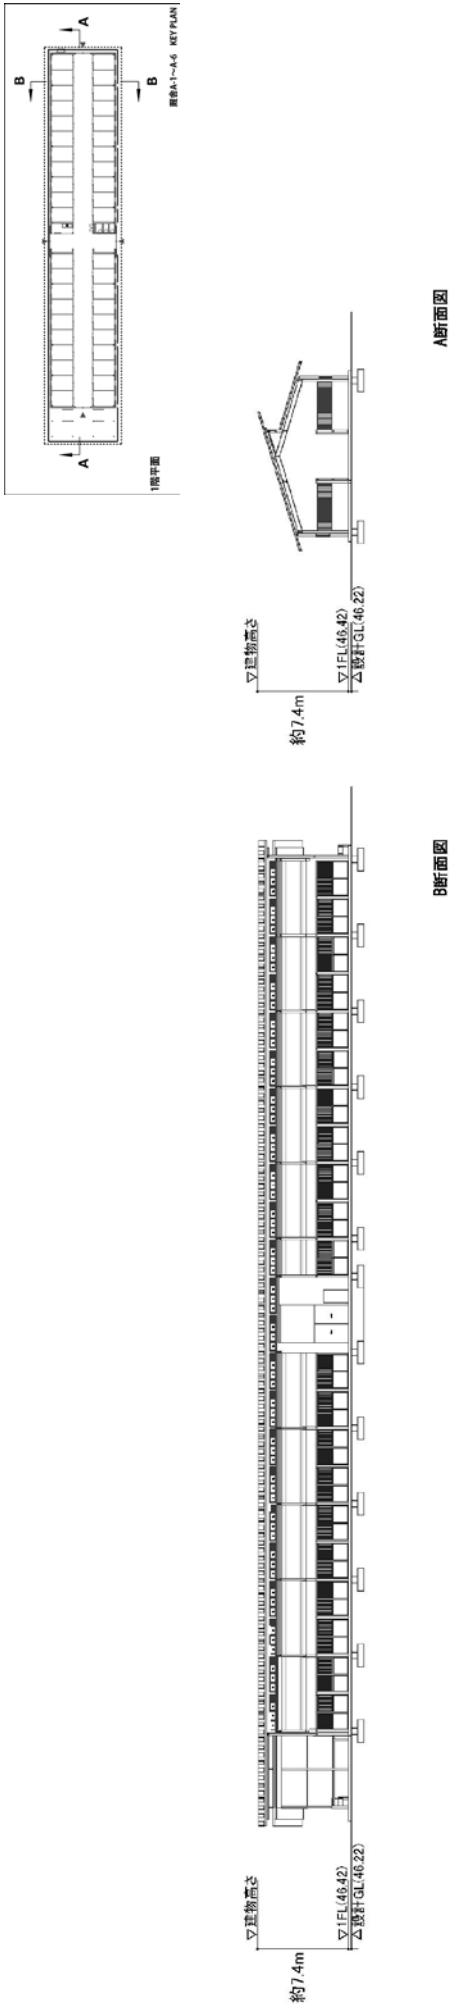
(5) 断面図 (厩舎 (A-1~A-6))
